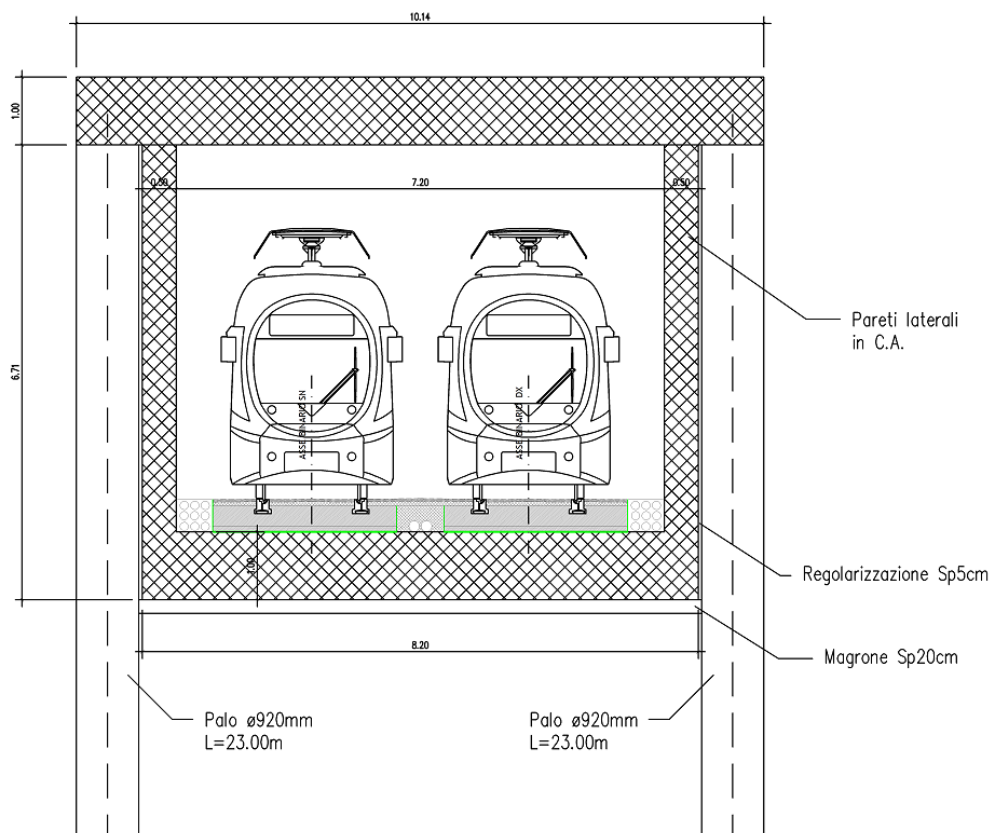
Sezione in corrispondenza del sottopasso – Sezione corrente
